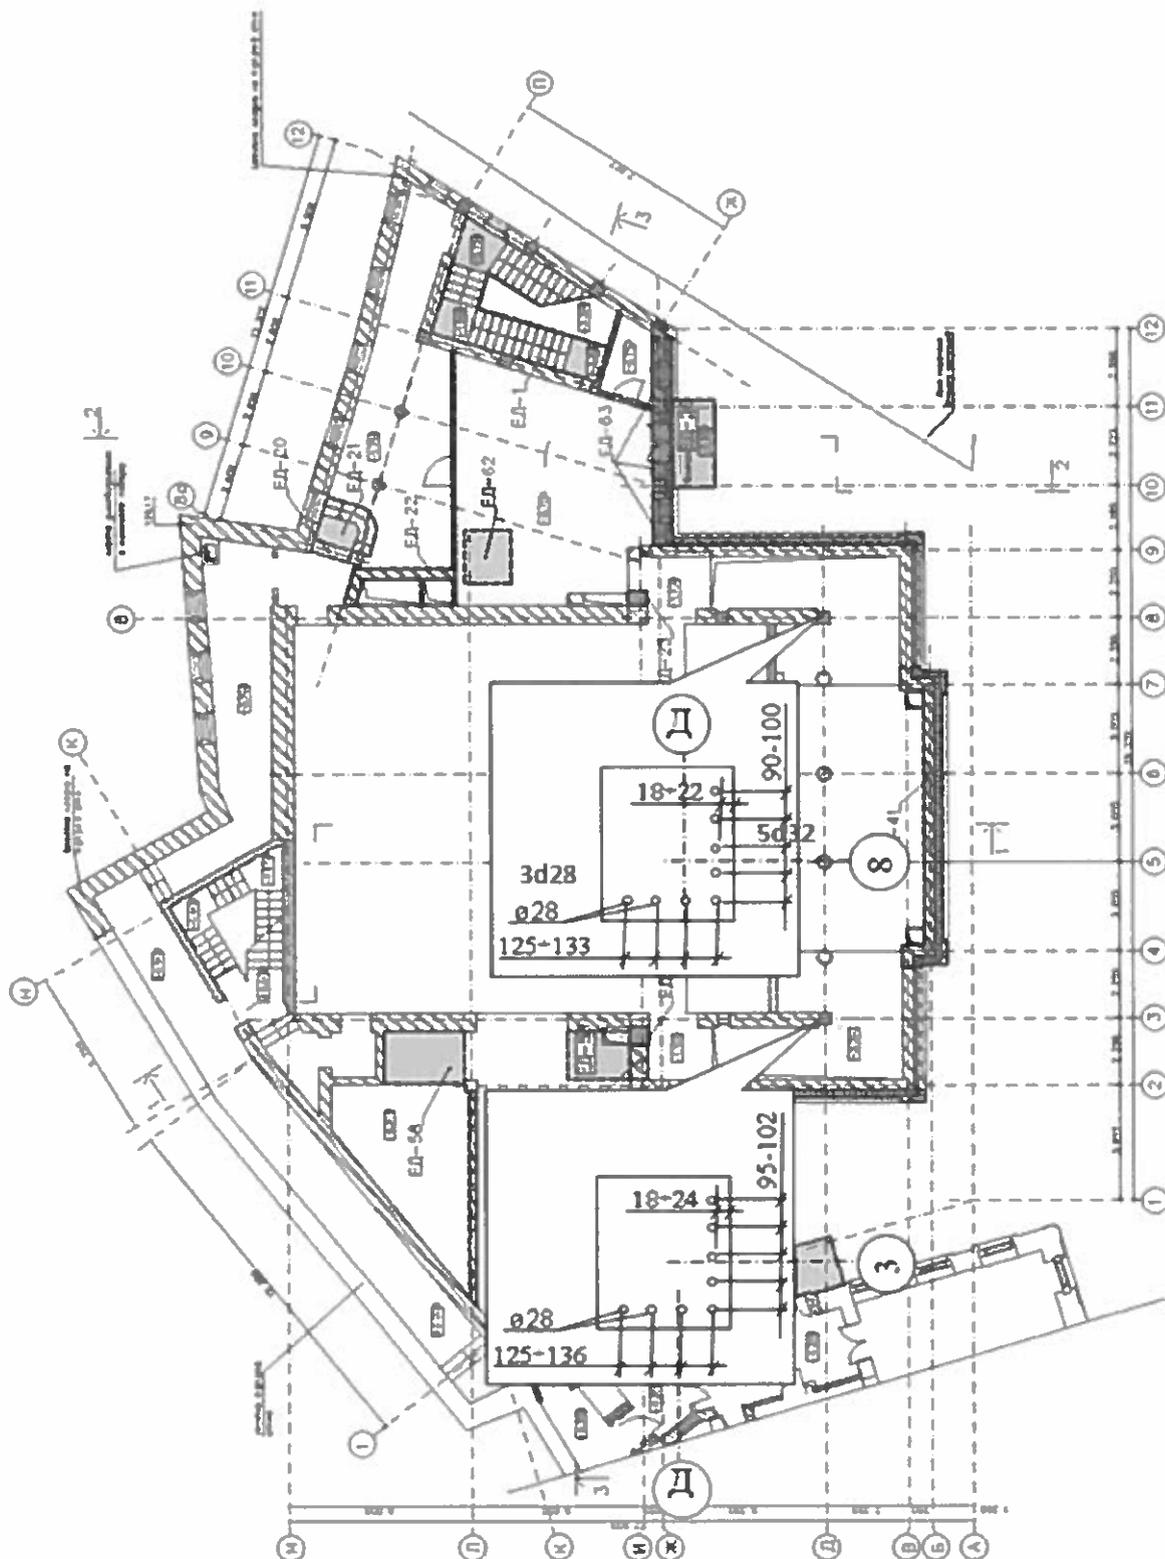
План будівлі на відмітці -1.100 з місцями визначення параметрів армування колон
